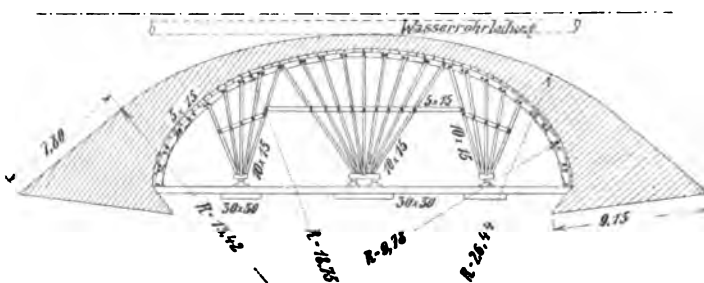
Lehrgerüst der Brücke über den San Leandro Creek.
